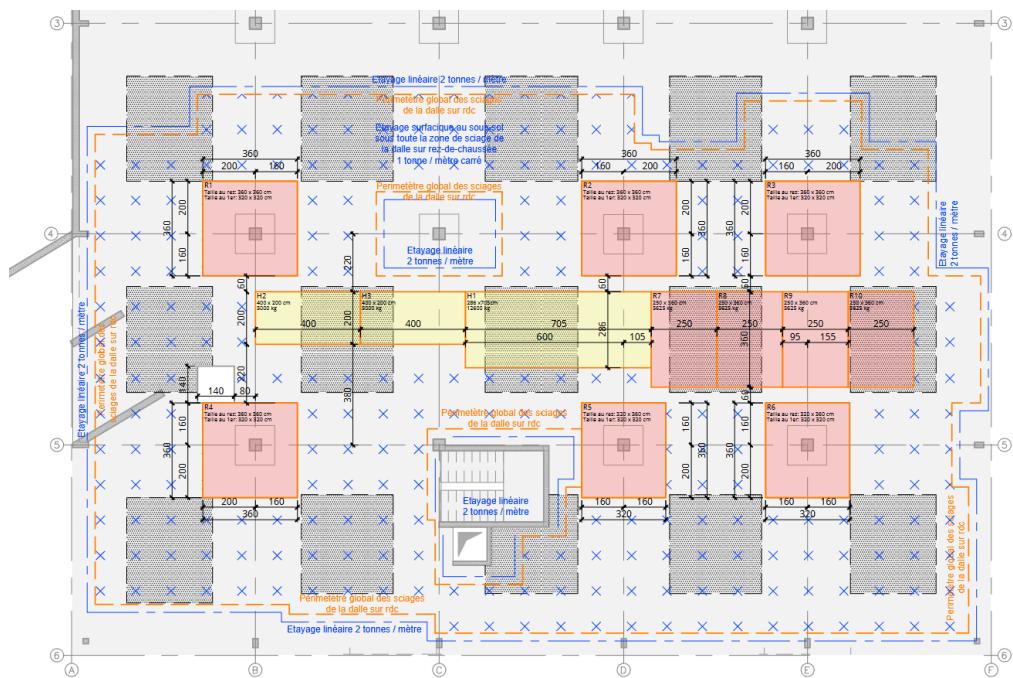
Plan de découpe de la dalle sur sous-sol du bâtiment existant
